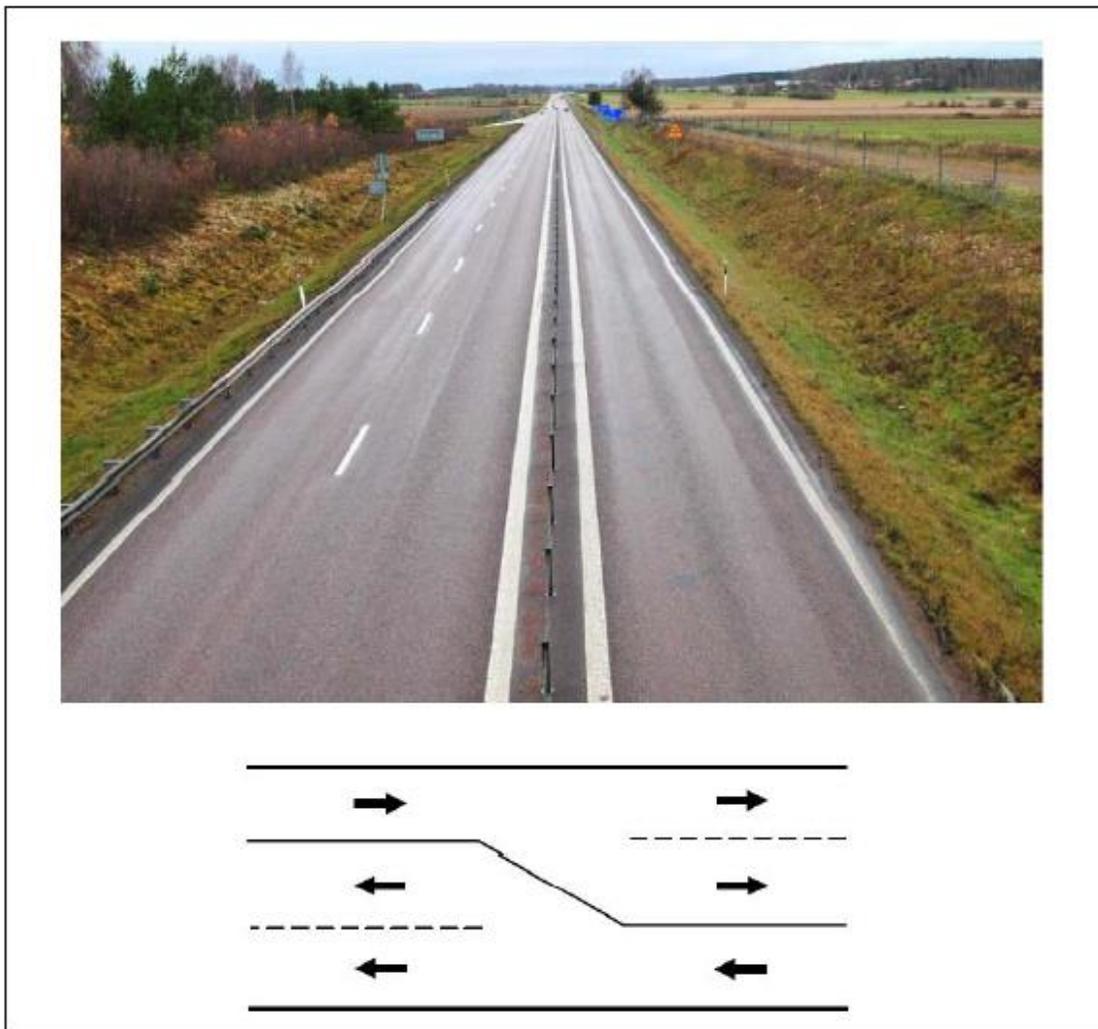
Vista en planta de la configuración de los caminos 2+1
